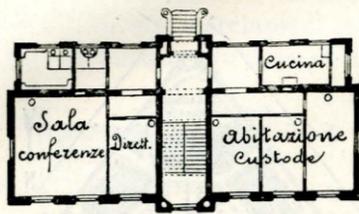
Pianta del piano terreno del padiglione a due piani.
